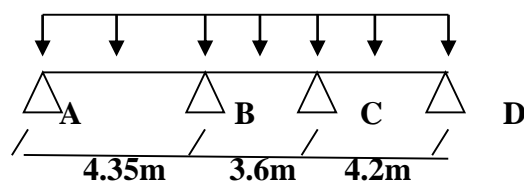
schéma statique de la poutre reposant sur 4 appuis.
